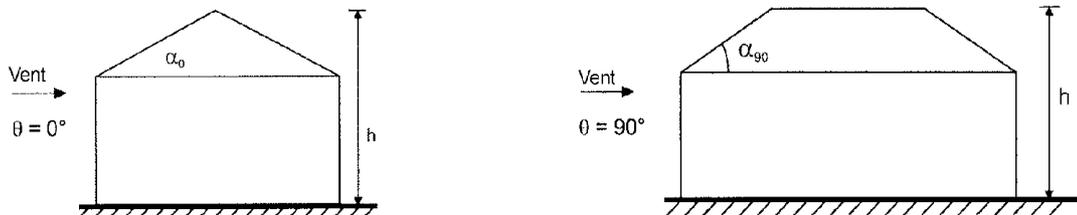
Schémas de toiture des maisons à 4 versants. A gauche vent appliqué sur long pan (grande façade), à droite vent appliqué sur pignon (petite façade).
